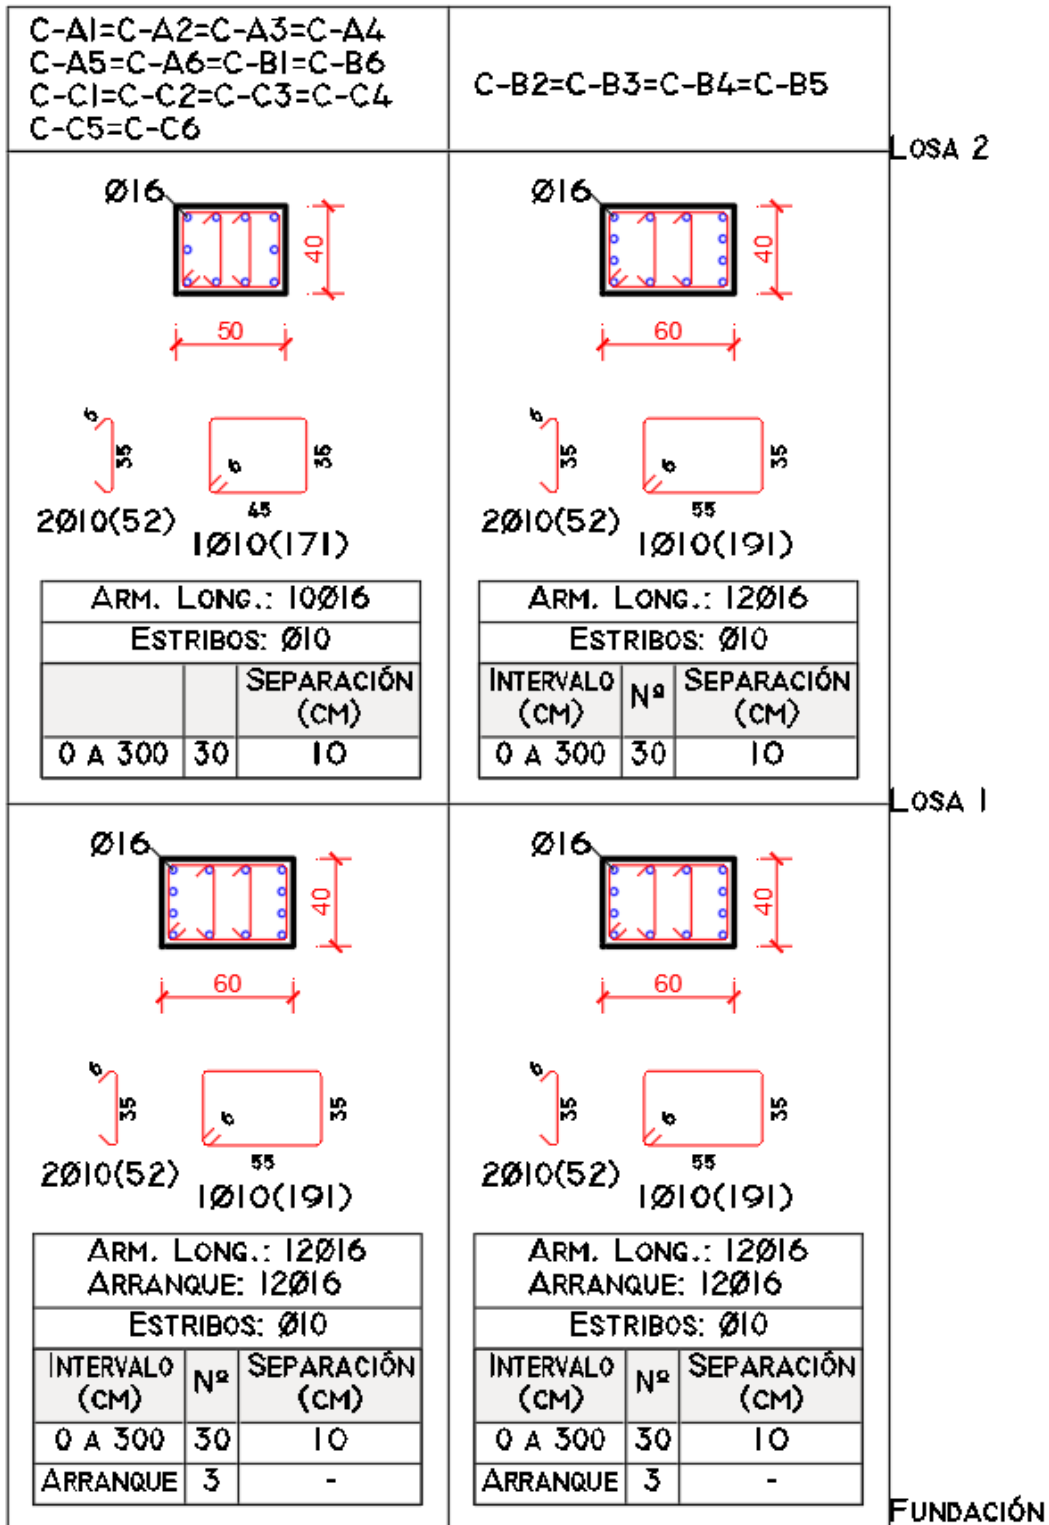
Detalle de Refuerzo Columnas, de Fundación a Losa 2, Estructura [7N-CS].
